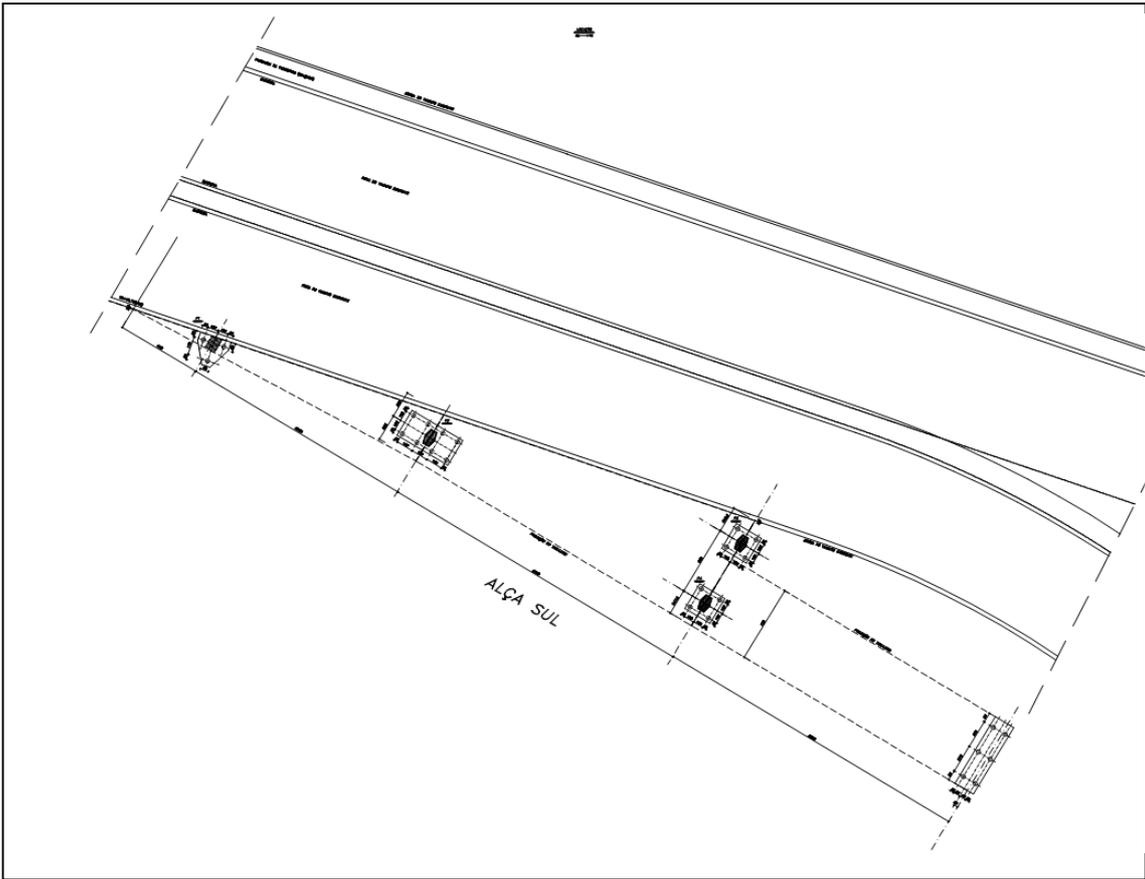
Planta de fundação inicialmente projetada com estacas pré-moldadas. (Fonte: VITÓRIO, 2014)
